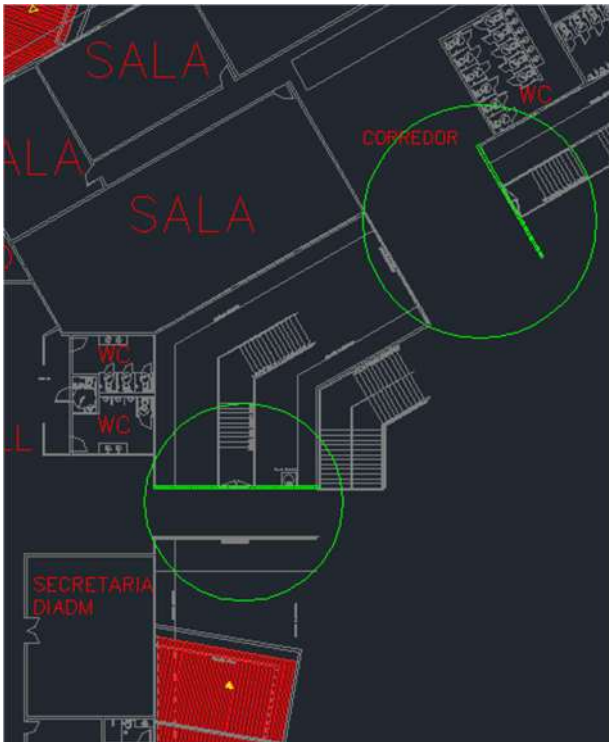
Alvenaria passarela/corredor 1º Pav. – Planta baixa Bloco B
